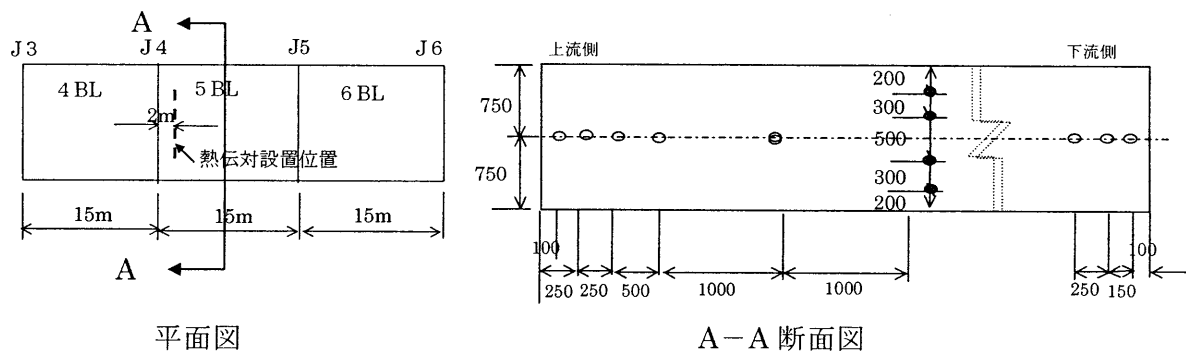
熱伝対配置平面図，断面図－5 BL－10lift
